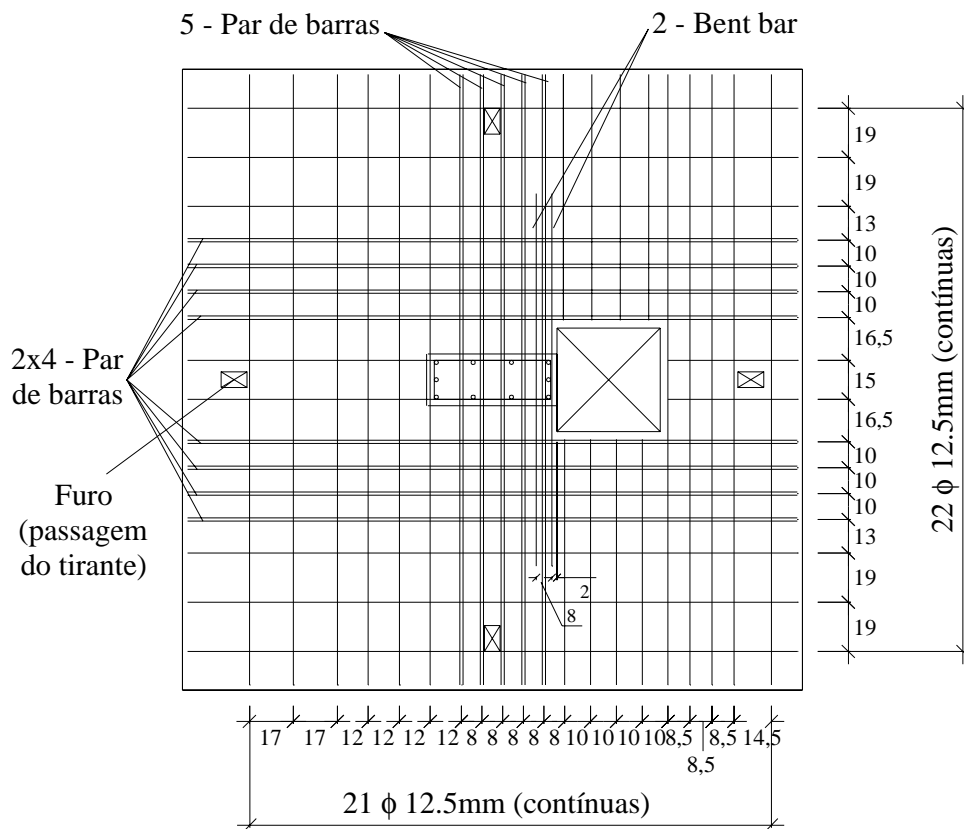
Posicionamento da armadura de cisalhamento da laje L5 (cm)
